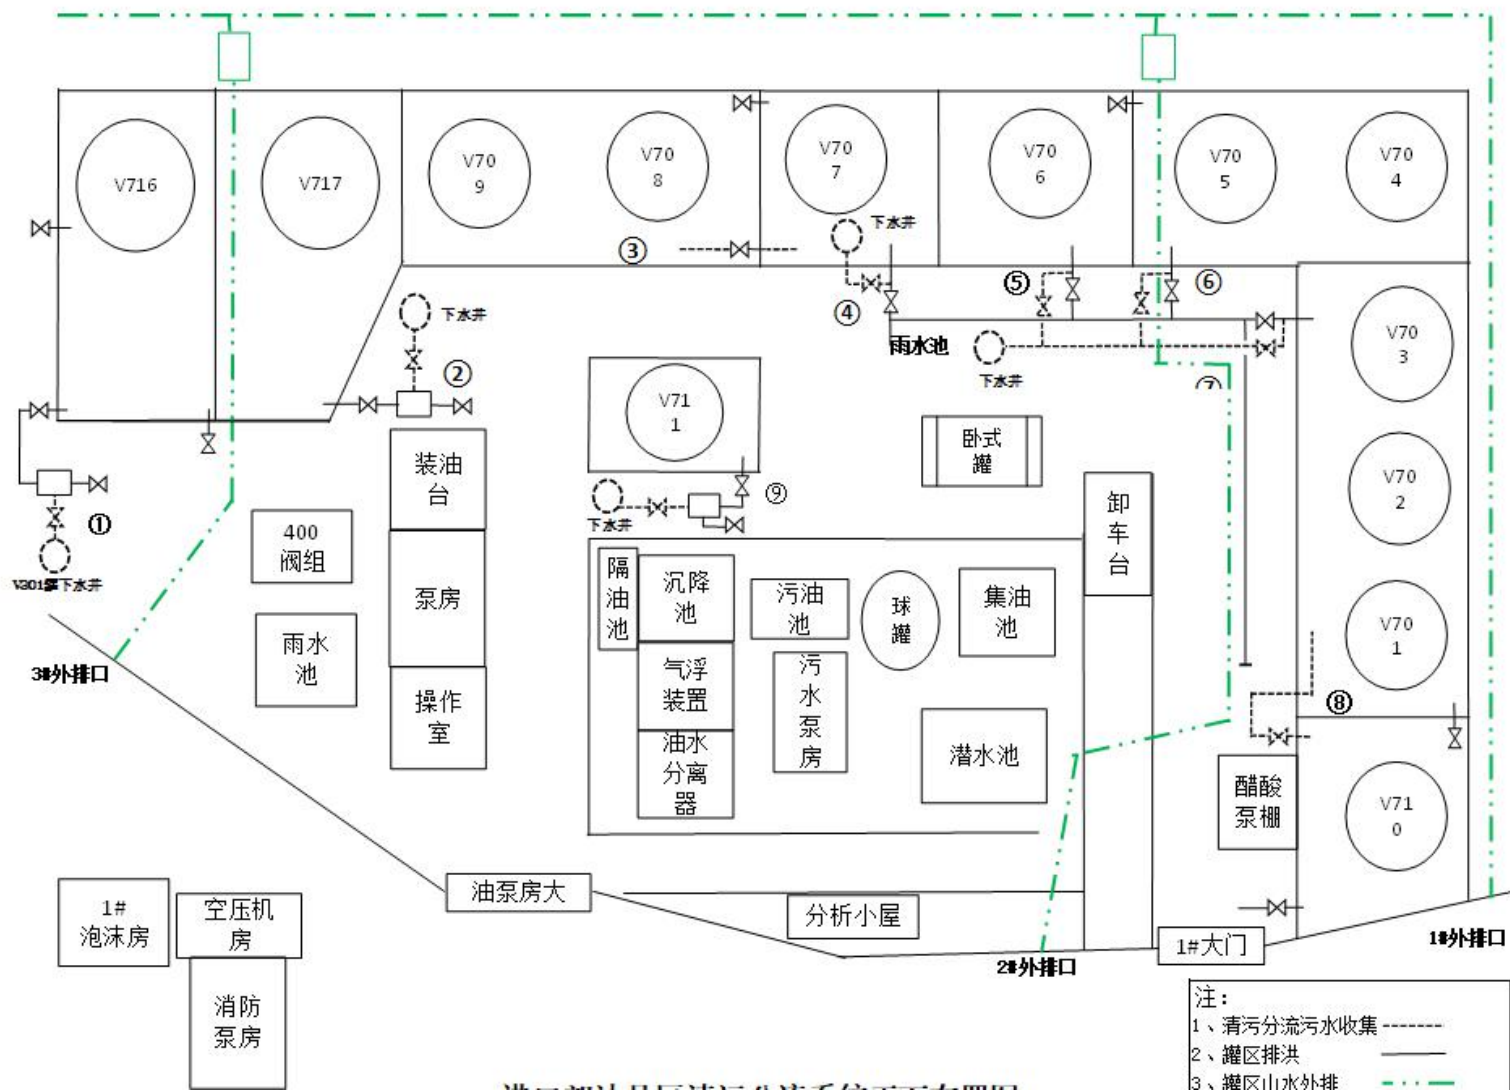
港口部沥青区、油品区、道仁矾平面布置图
